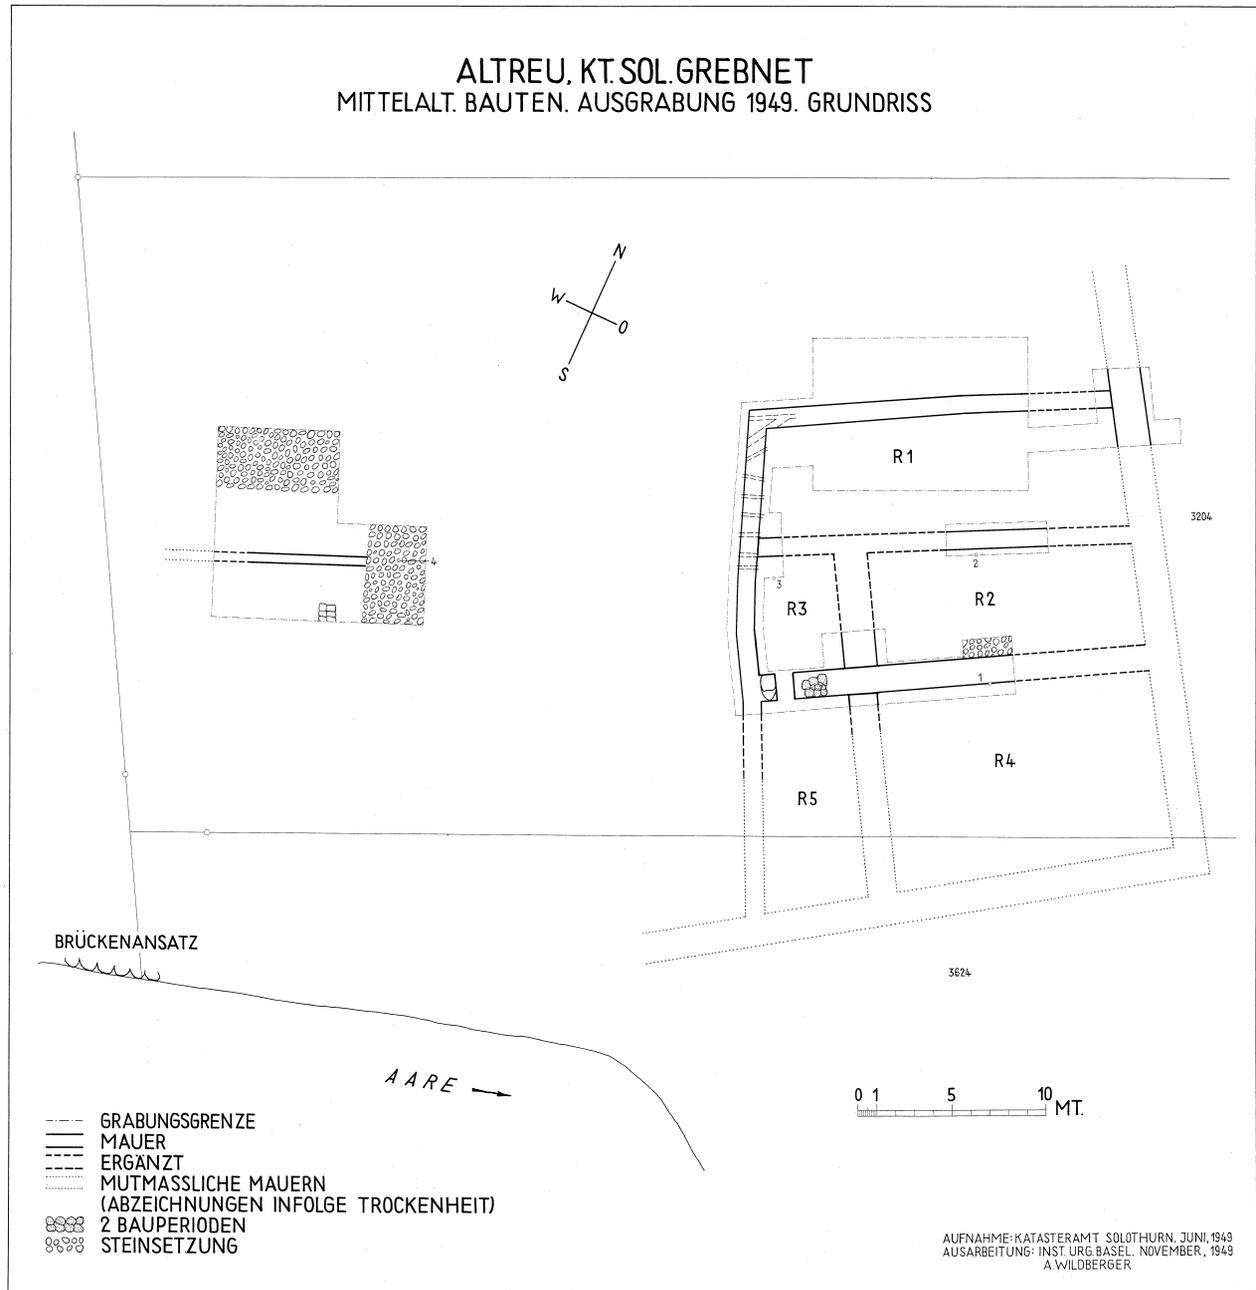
Altreu SO. Grundriss der 1949 ausgegrabenen Stadtburg nach René Wyss. Reproduktion M. 1:400.
